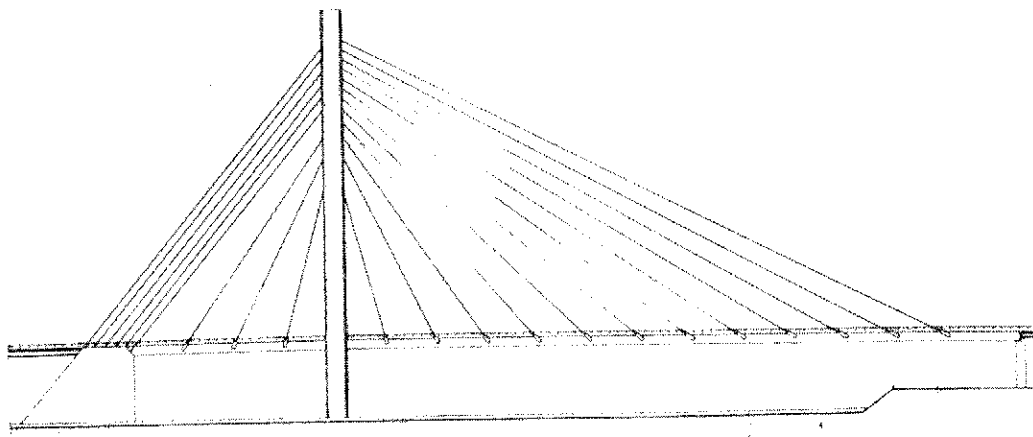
Puente atirantado con doble plano de cables. Alzado.
